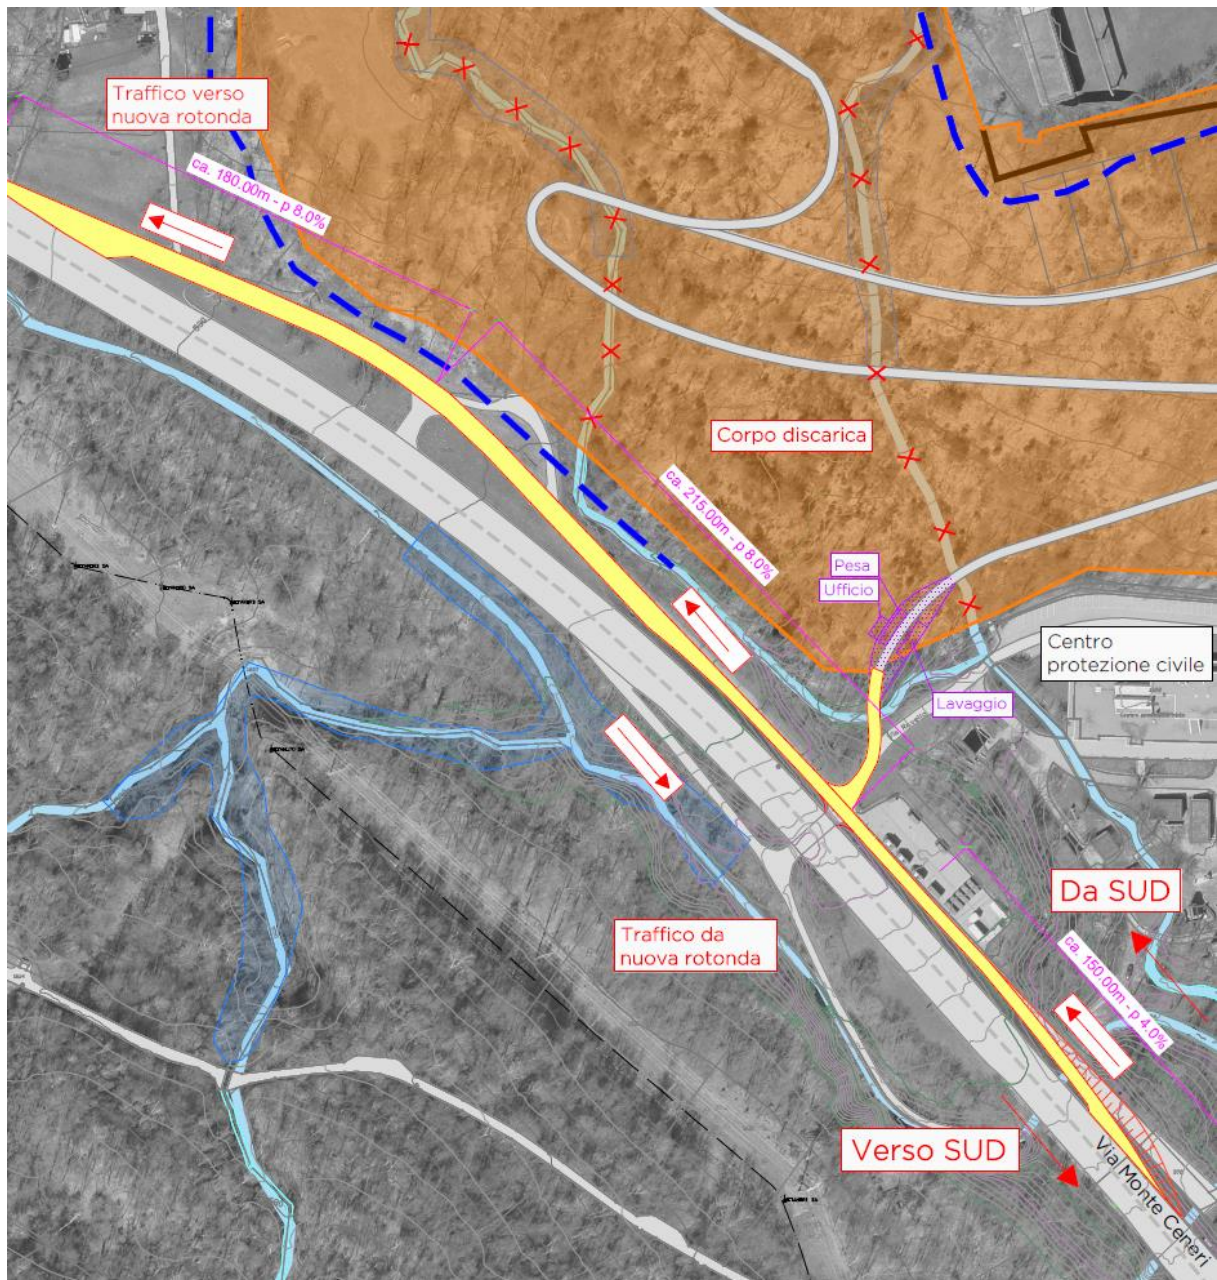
Planimetria accessi variante B-zona di entrata e uscita dalla discarica
